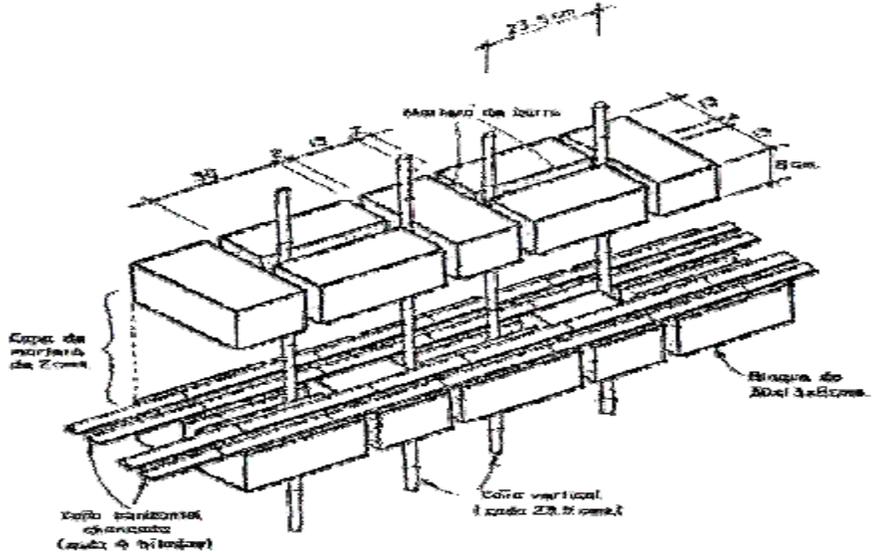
Esquema de Colocado del Refuerzo de Caña.
